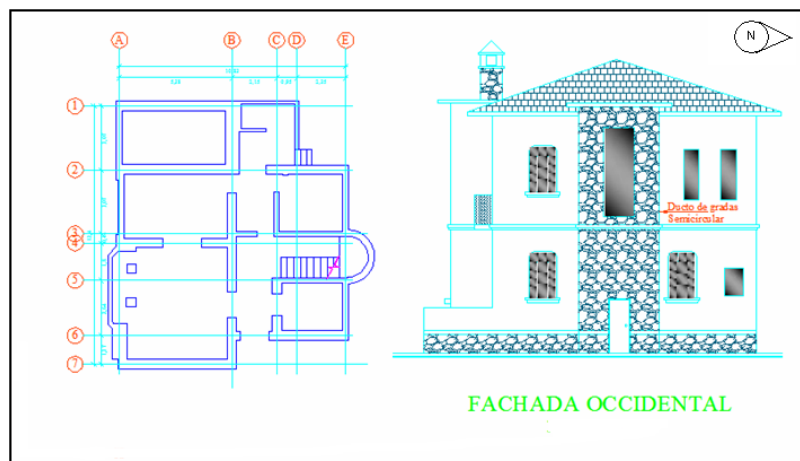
Planta y Elevación Residencia Ibarra – Camacho
